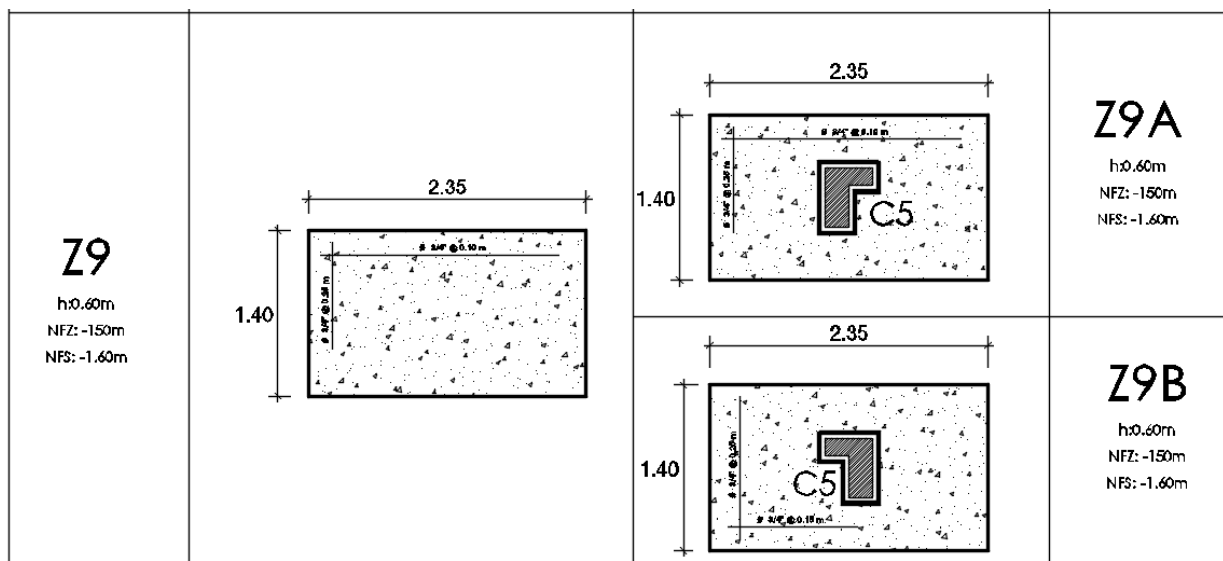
Acero en zapata Z9 y variaciones según ubicación de la columna, del sector desarrollado
